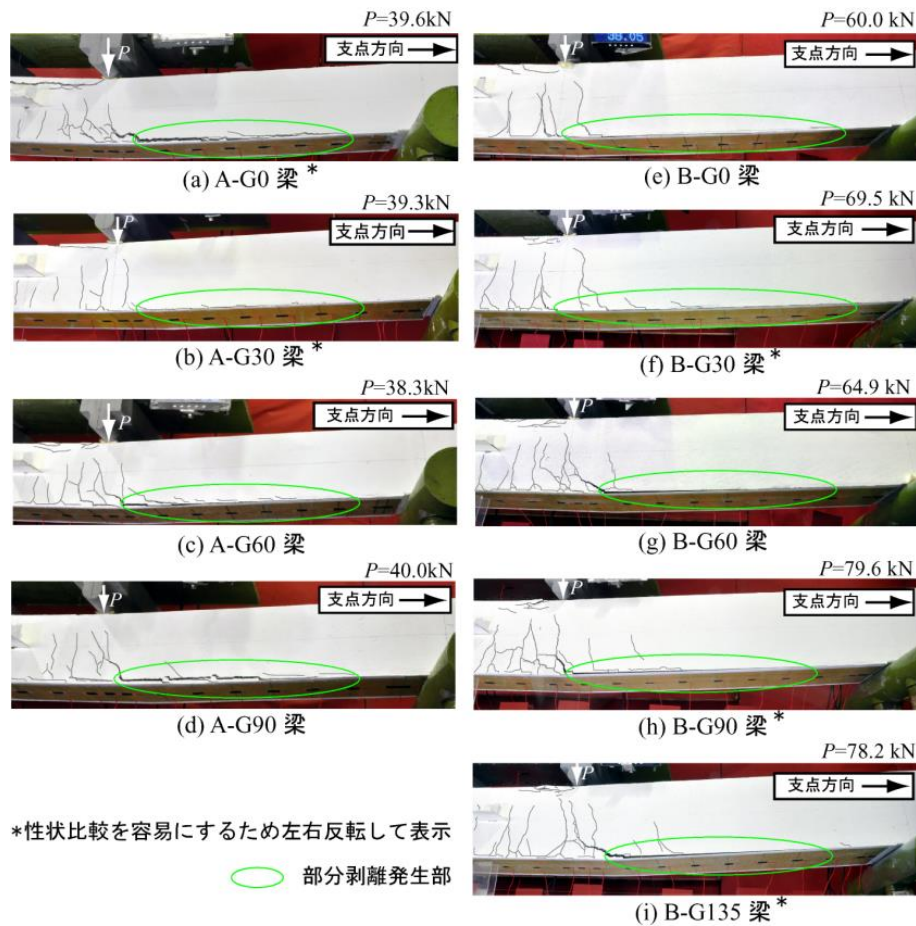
各試験体の補強材剥離および破断直前のひび割れ性状
